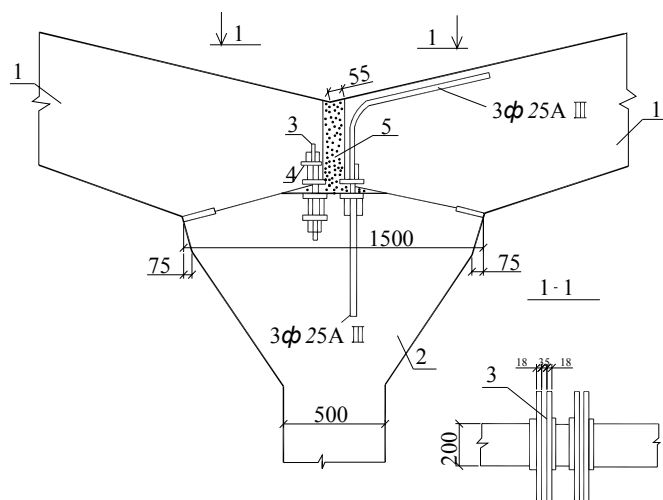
Варіант №2 конструкції вузла з'єднання ригелів з середньою стійкою (ЦННІЕПсельстрой): 1 – ригель; 2-середня стійка; 3- високоміцний болт $\Phi 27$; 4-шайба; 5 – цементний розчин
